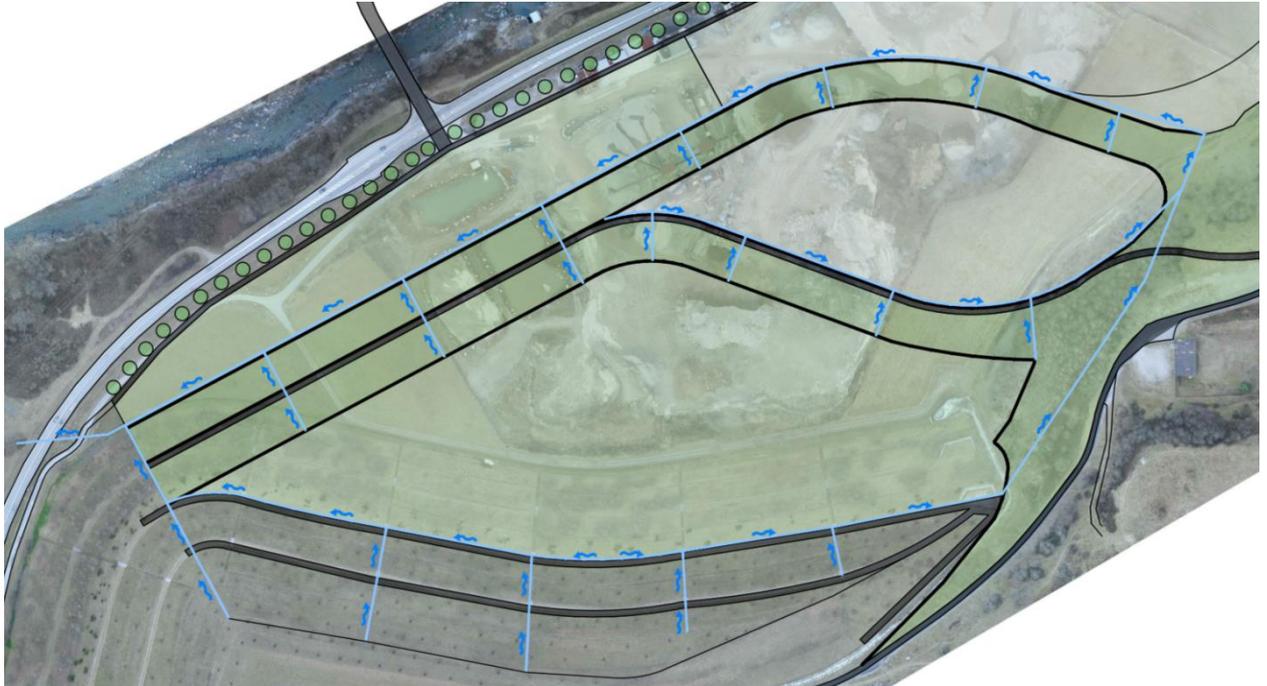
Planimetria generale sistema di raccolta acque meteoriche
